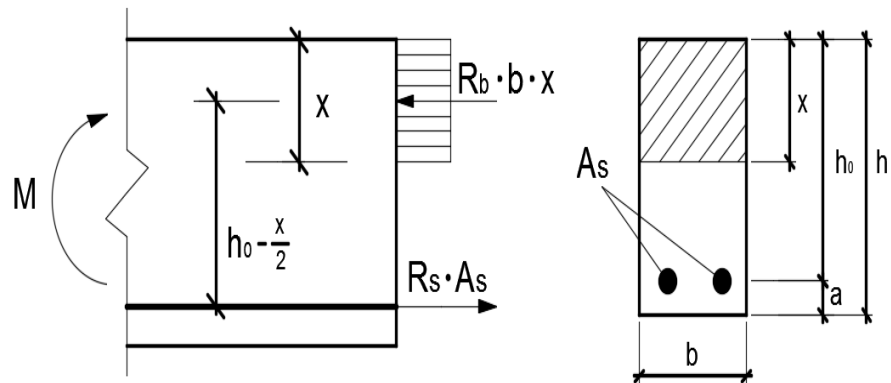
Схема усилий в изгибаемом элементе прямоугольного сечения с одиночной арматурой
